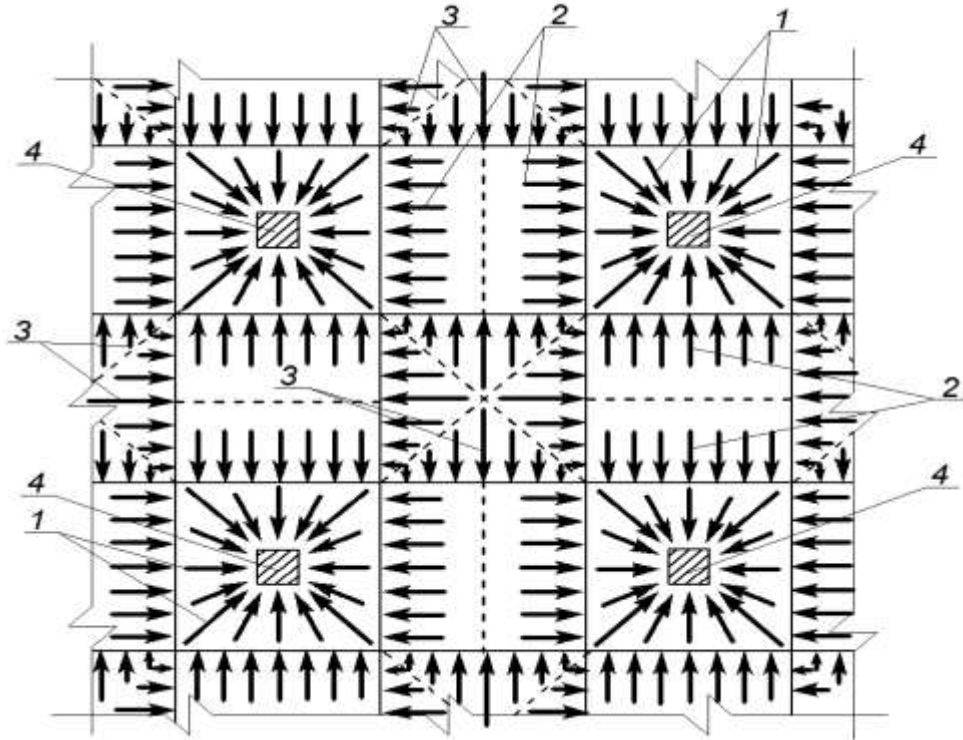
Розрахункова схема передавання навантаження в збірному безкапітельно-безбалковому каркасі: 1 – із надколонних плит на колону; 2 – із міжколонних плит на надколонні плити; 3 – із середніх плит на міжколонні плити; 4 – колони
